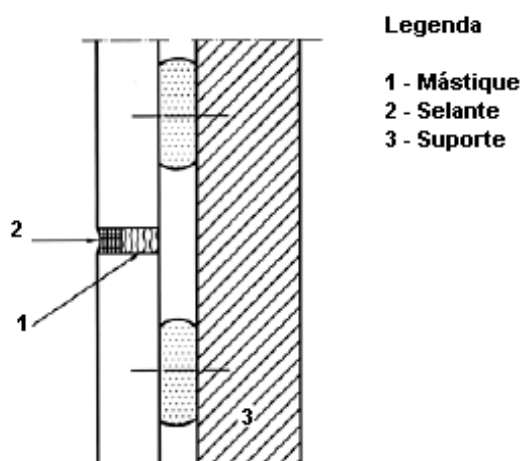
Exemplo de junta fechada. Adaptado de [34]
